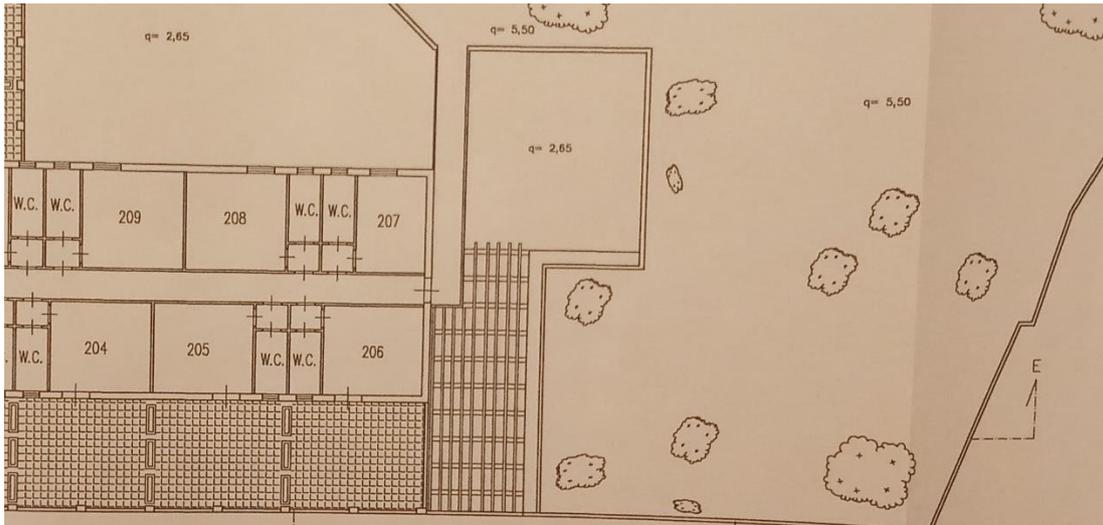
Planimetria stato attuale piano primo immobile 1 non completo
